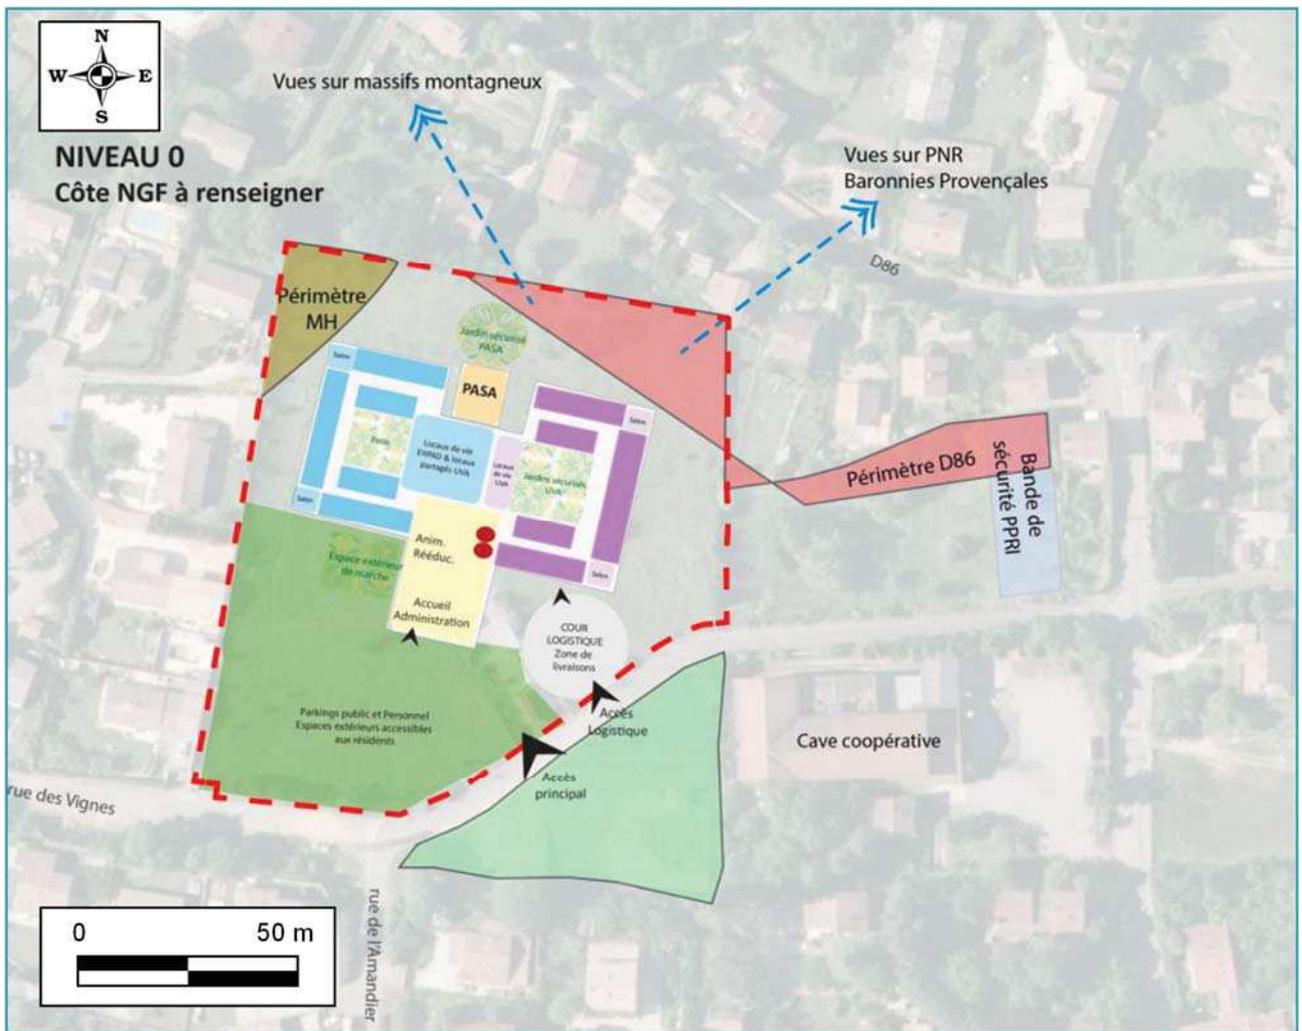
Plan de masse potentiel du projet (Source : SERL)
